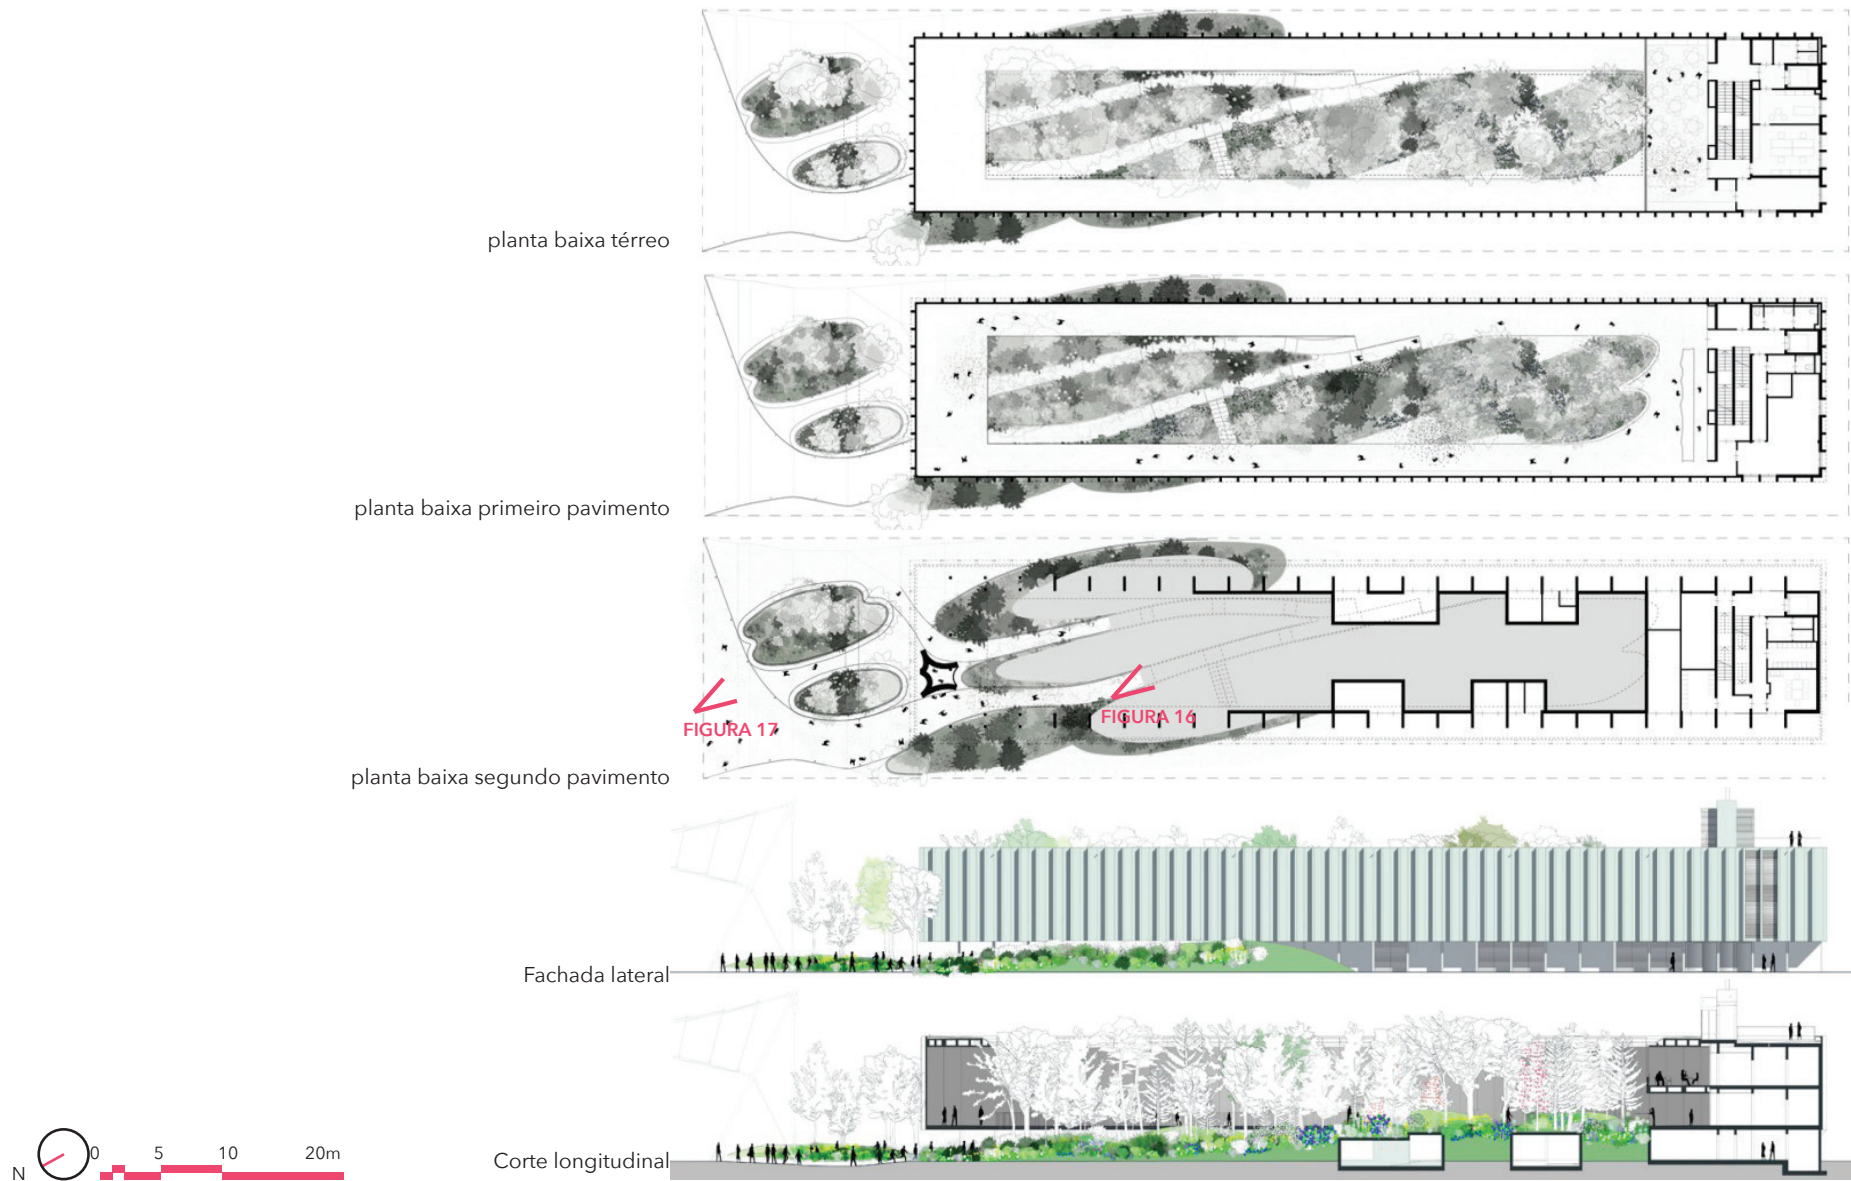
Plantas baixas, Elevação externa e corte longitudinal do pavilhão - relação exterior-interior
